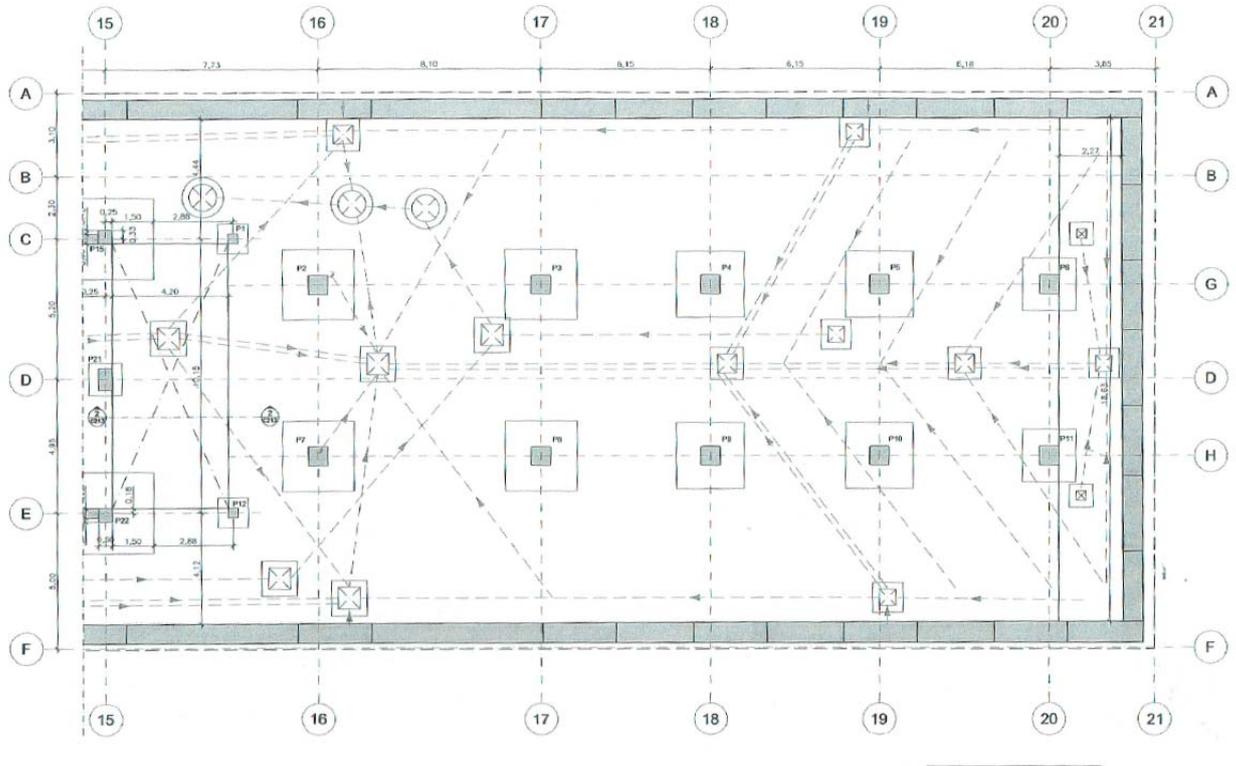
Planta de cimentación bajo la proyección de la posible ubicación de pabellón (Zona B)
